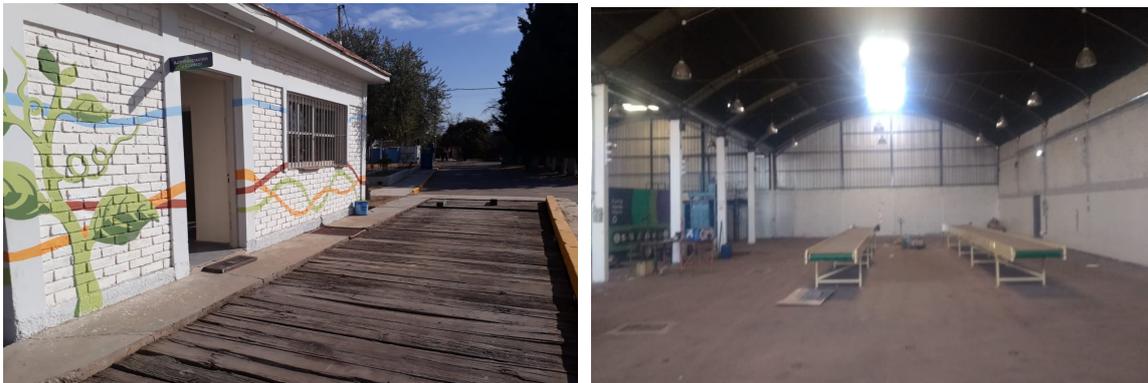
Fotos Galpón para instalación de Planta en Guaymallén – junio de 2019
